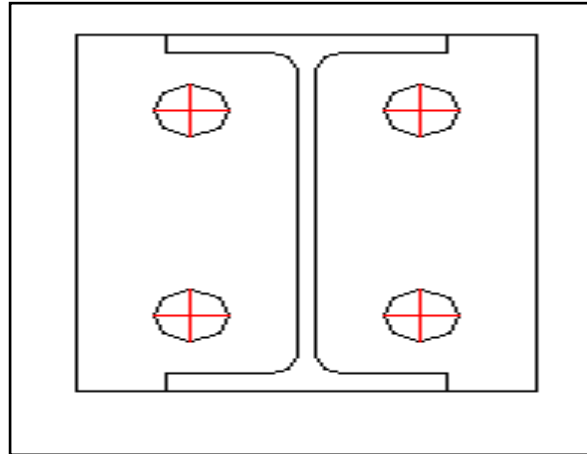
Représentation de l'assemblage Poteau –poutre sablière
